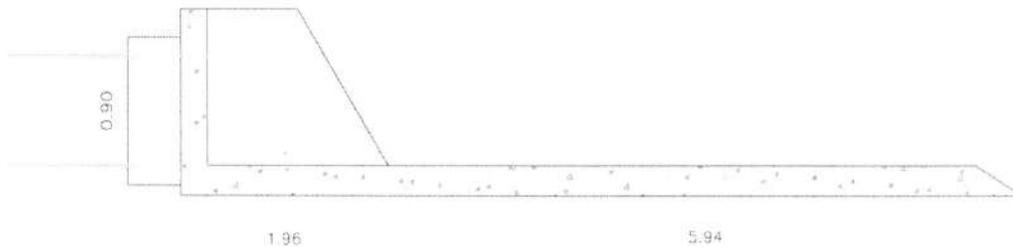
Detalle planta de dimensiones de la estructura de entrega del colector pluvial en la acequia Las Mercedes<sup>7</sup>.
